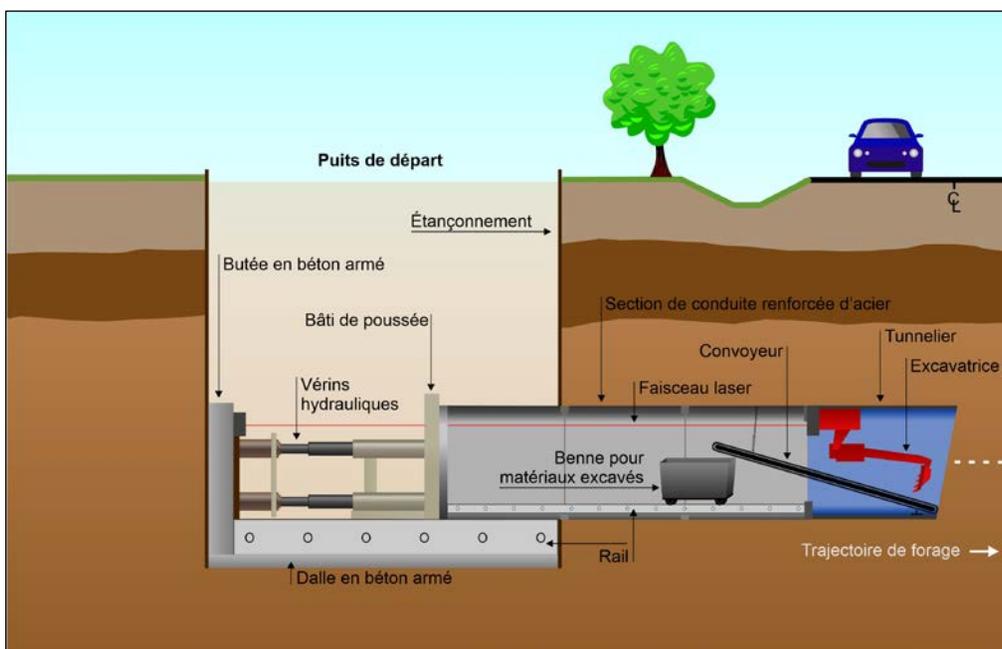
Schéma de tunnelier standard à bouclier ouvert à excavation mécanisée
